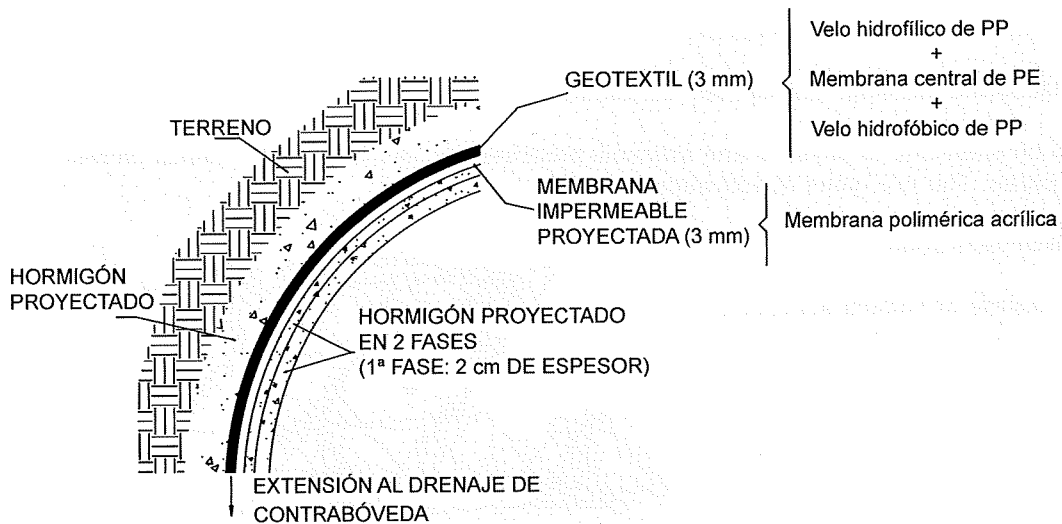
Sección tipo del sistema de impermeabilización con membranas proyectables continuas.
